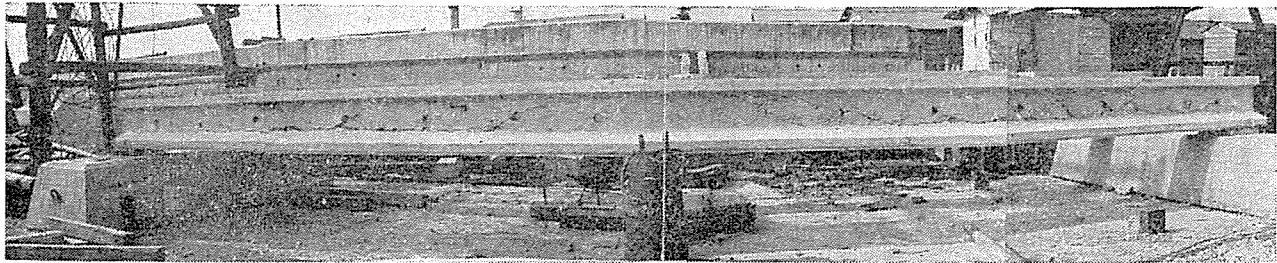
軽量コンクリート柄クラック状況 (手前は落させた重量物)
